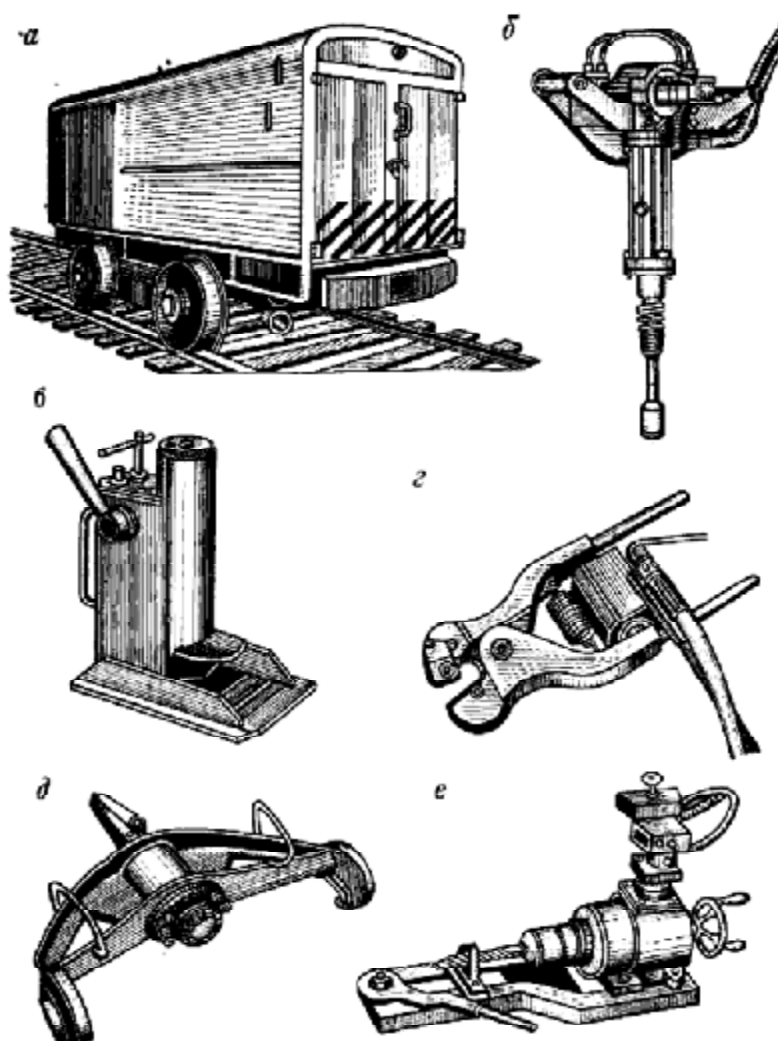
Путевая установка ПГИ-2 с набором инструмента для путевых работ: *а* — передвижная установка; *б* — костылезабивщик; *в* — домкрат; *г* — кусачки; *д* — рельсогибочный пресс; *е* — рельсосверлильный станок
